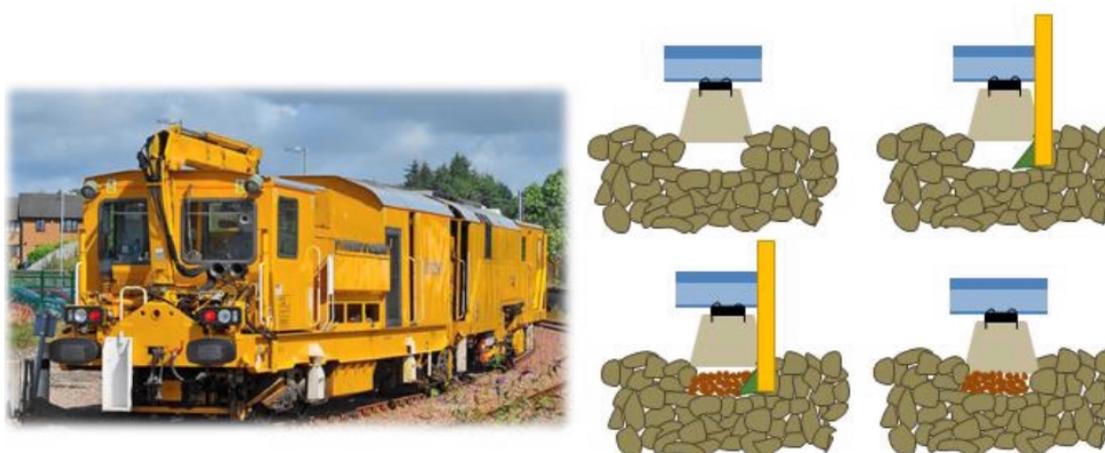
stoneblower y proceso de aplicación de los áridos bajo traviesa.
